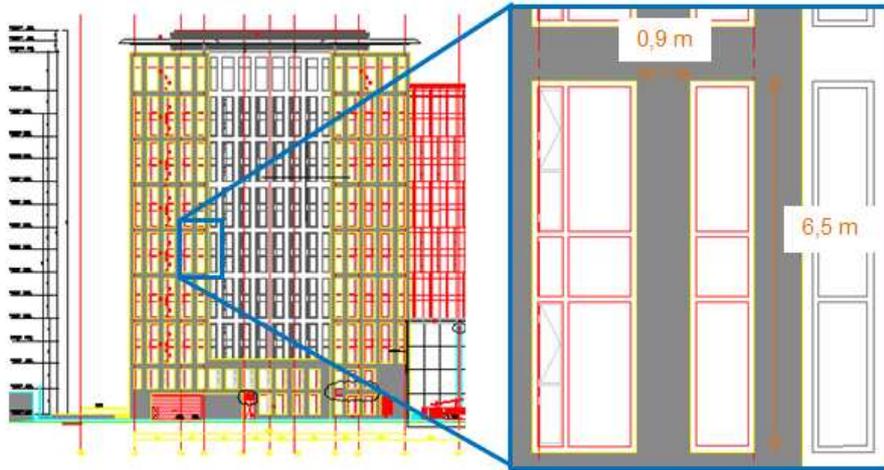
Façade sud du bâtiment Pole Star et zoom [8]
